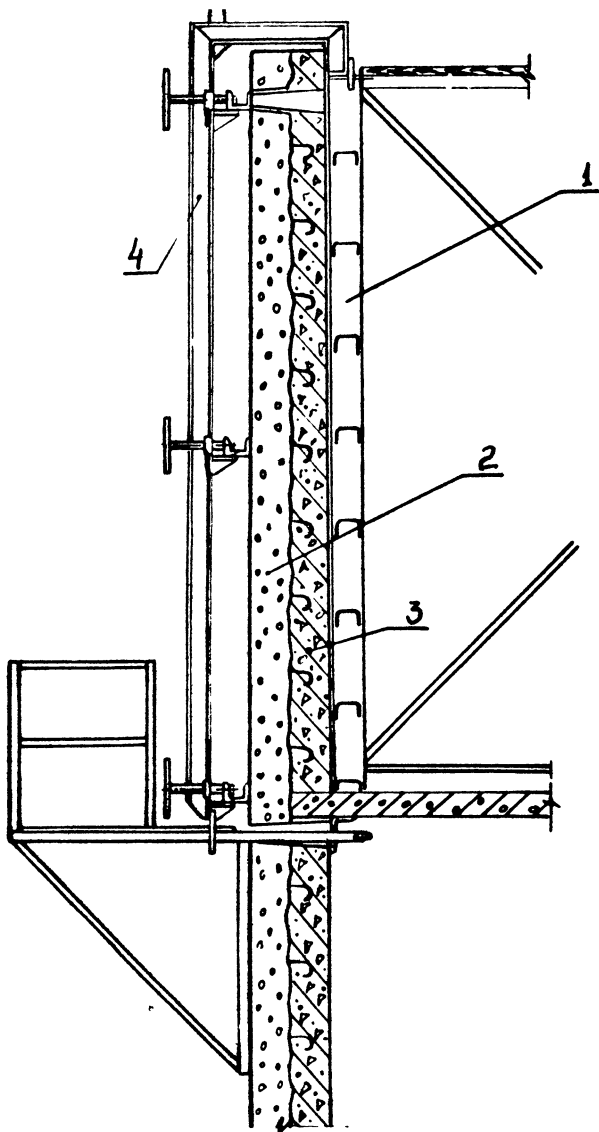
Устройство наружной стены со сборными панелями-скорлупами:
